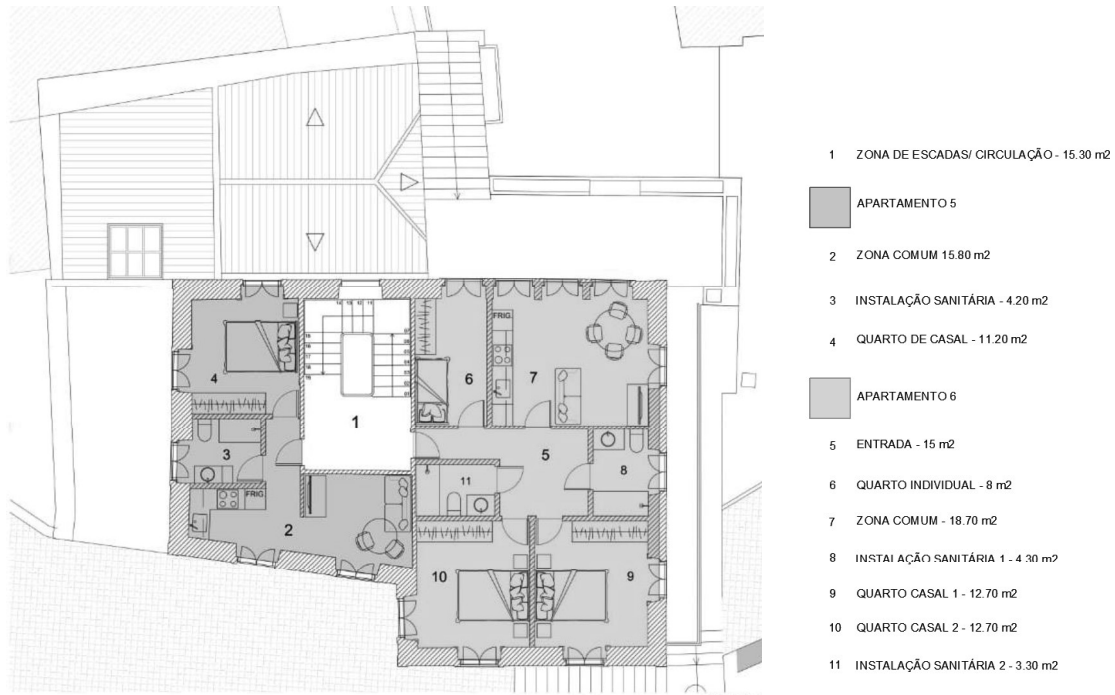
Planta Final zonamentos, Piso 1 (s/escala) | Beatriz Figueiredo
